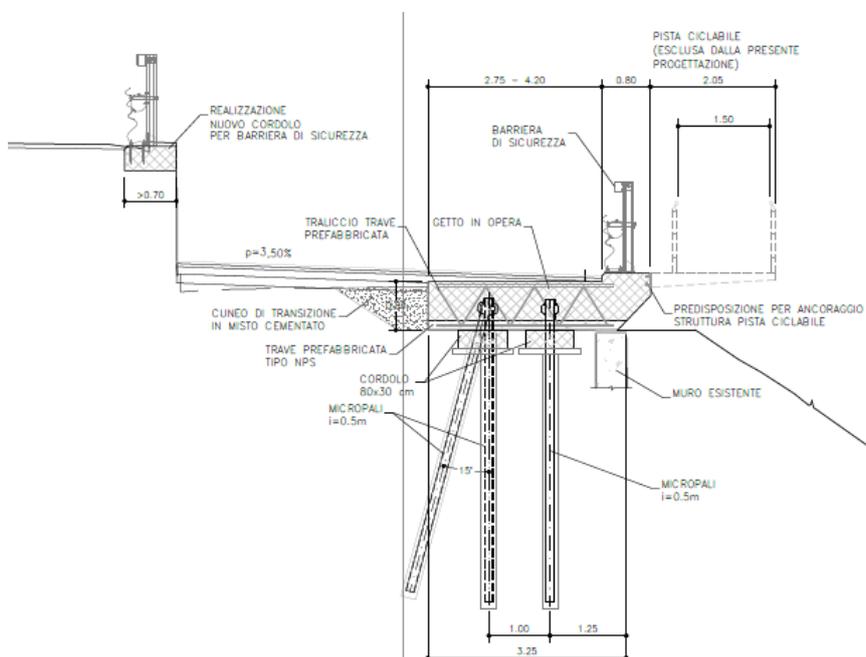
Sezione soletta a sbalzo nel tratto iniziale.
